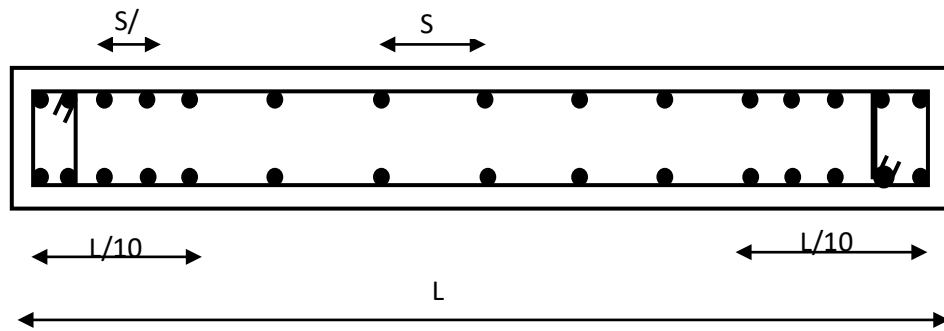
Disposition des armatures verticales (vue en plan).
